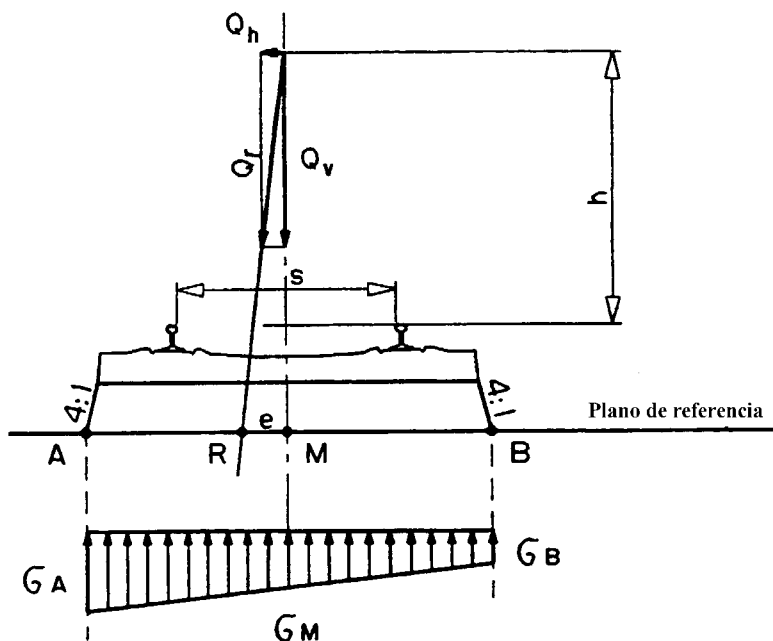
Distribución transversal de las cargas a través de las traviesas y del balasto en vías sin peralte
